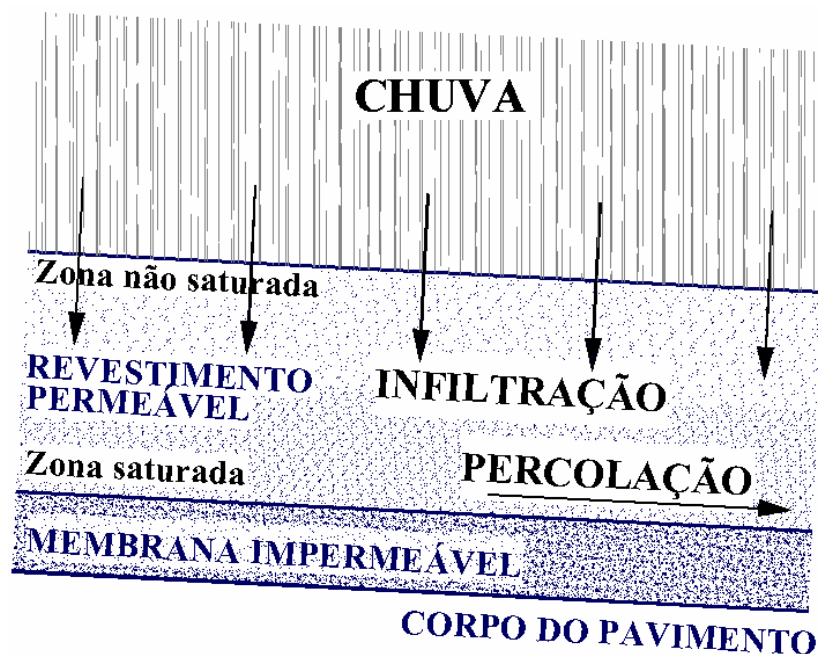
Drenagem e infiltração em revestimento drenante molhado (GNCSC, 1996).
